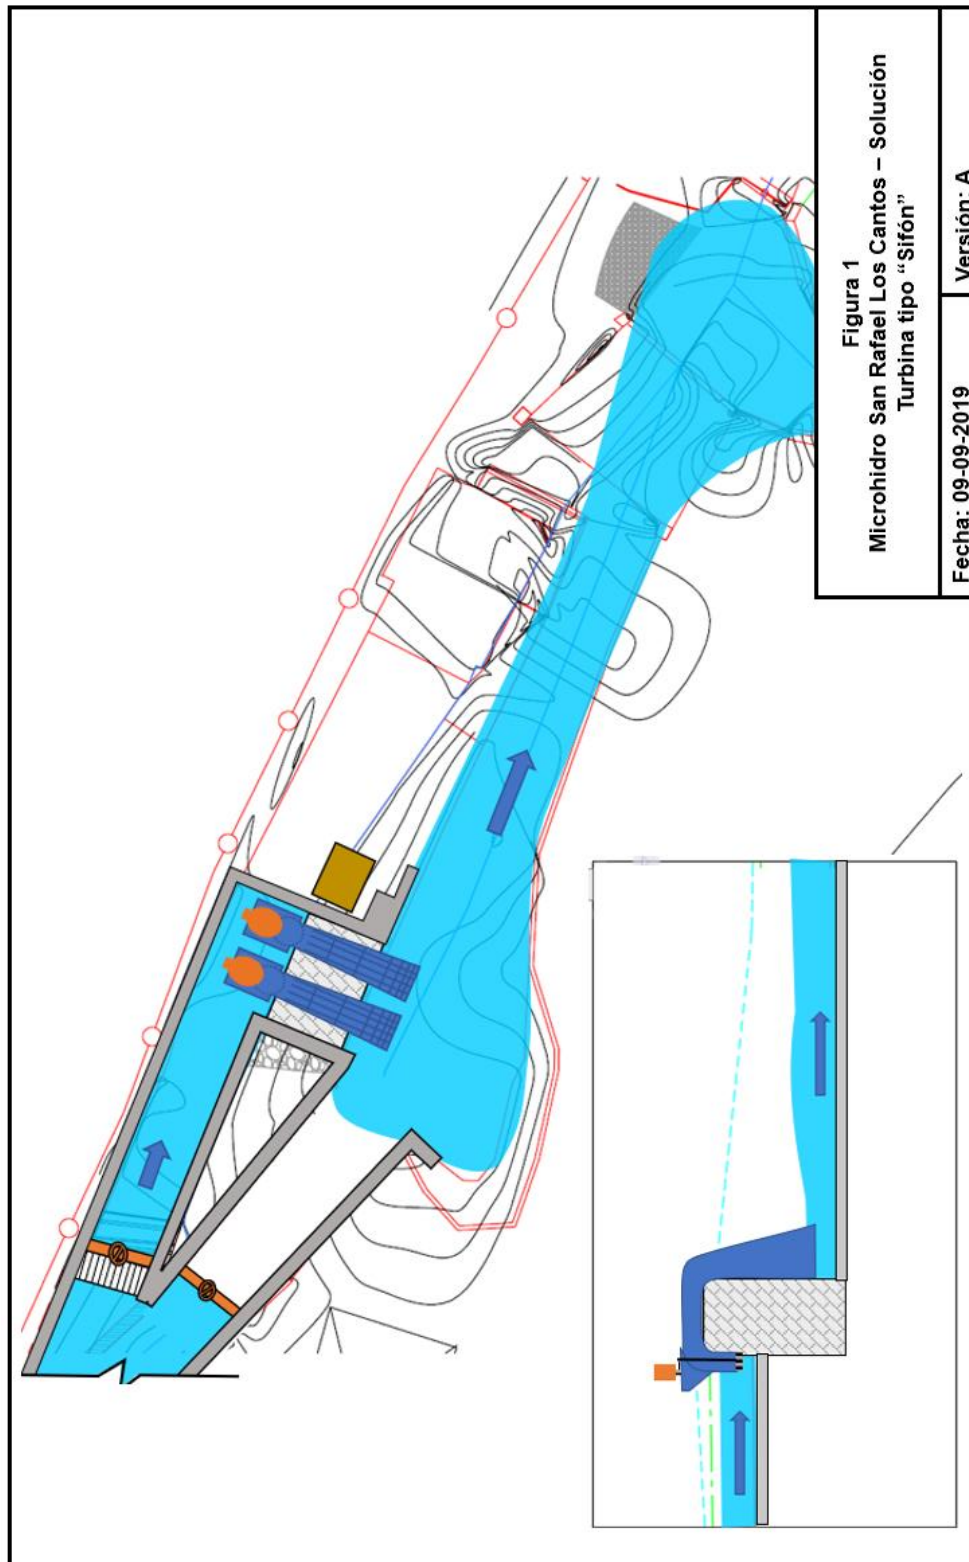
Esquema de implantación de una central de generación tipo "Sifón"; vista en planta y elevación
